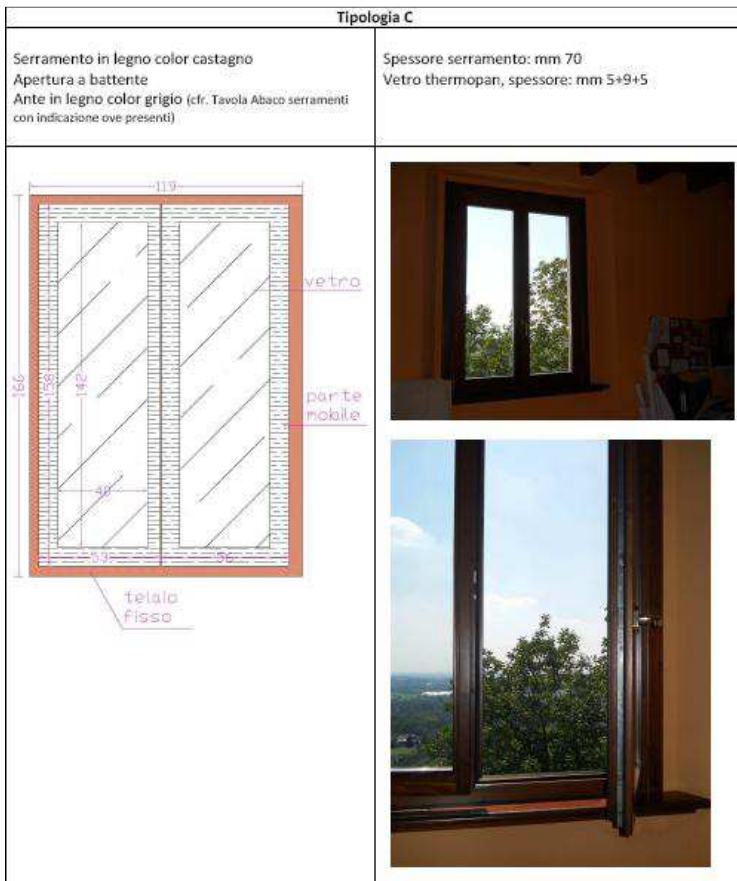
finestra tipo di Ca' Soldato
